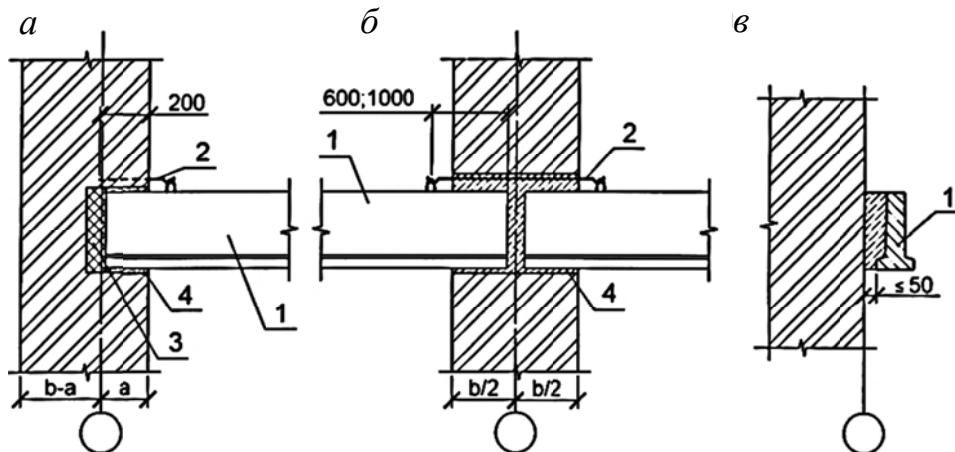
Узлы сопряжения сборных железобетонных балок со стенами:
